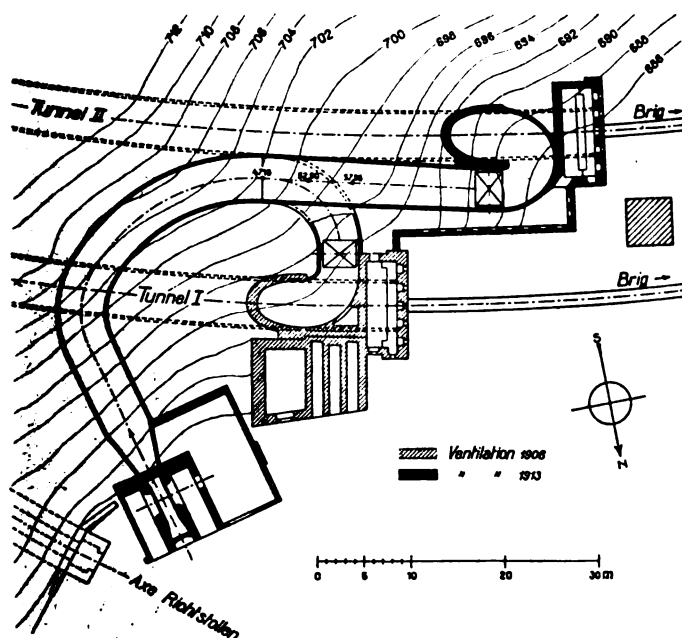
Lageplan der Simplon-Ventilations-Anlage. — 1:800.
